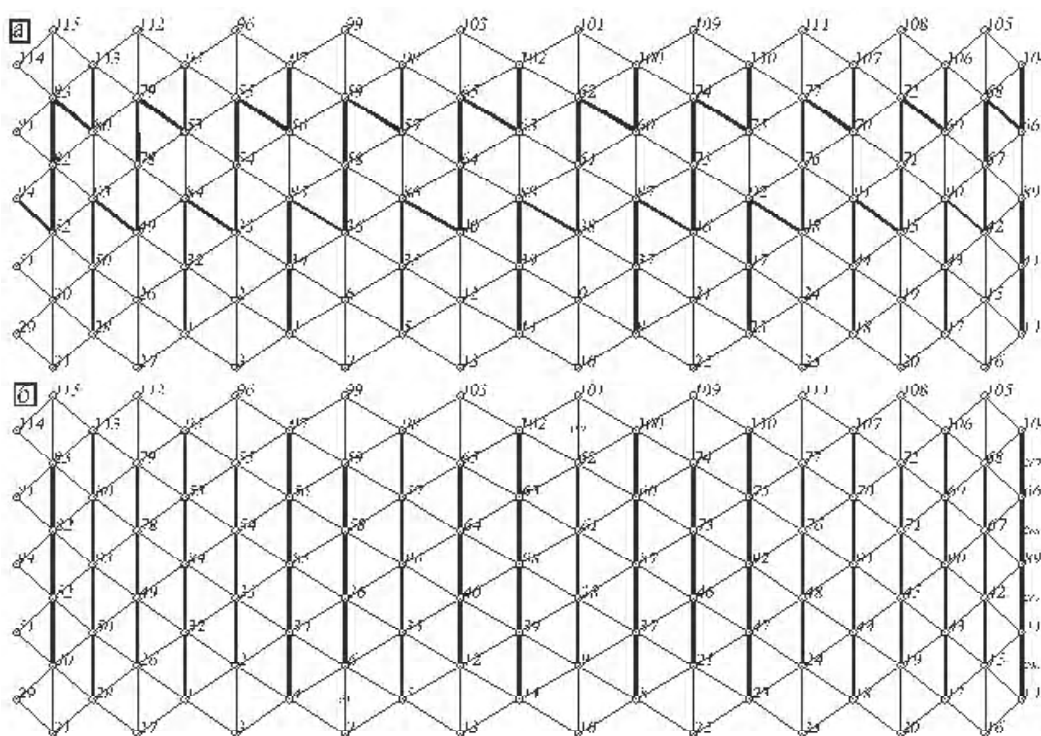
Схема нагружения оболочки монтажными воздействиями: а – при продольной схеме сборки; б – при поперечной схеме сборки.
